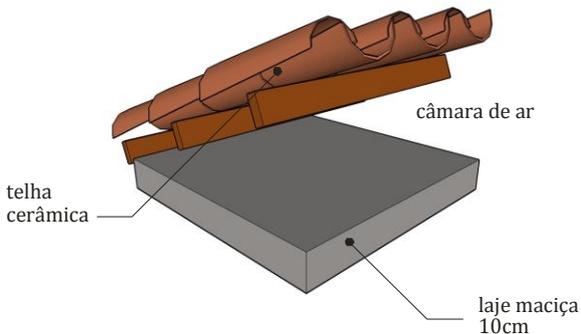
Características da cobertura com telha de cerâmica e laje de concreto.
